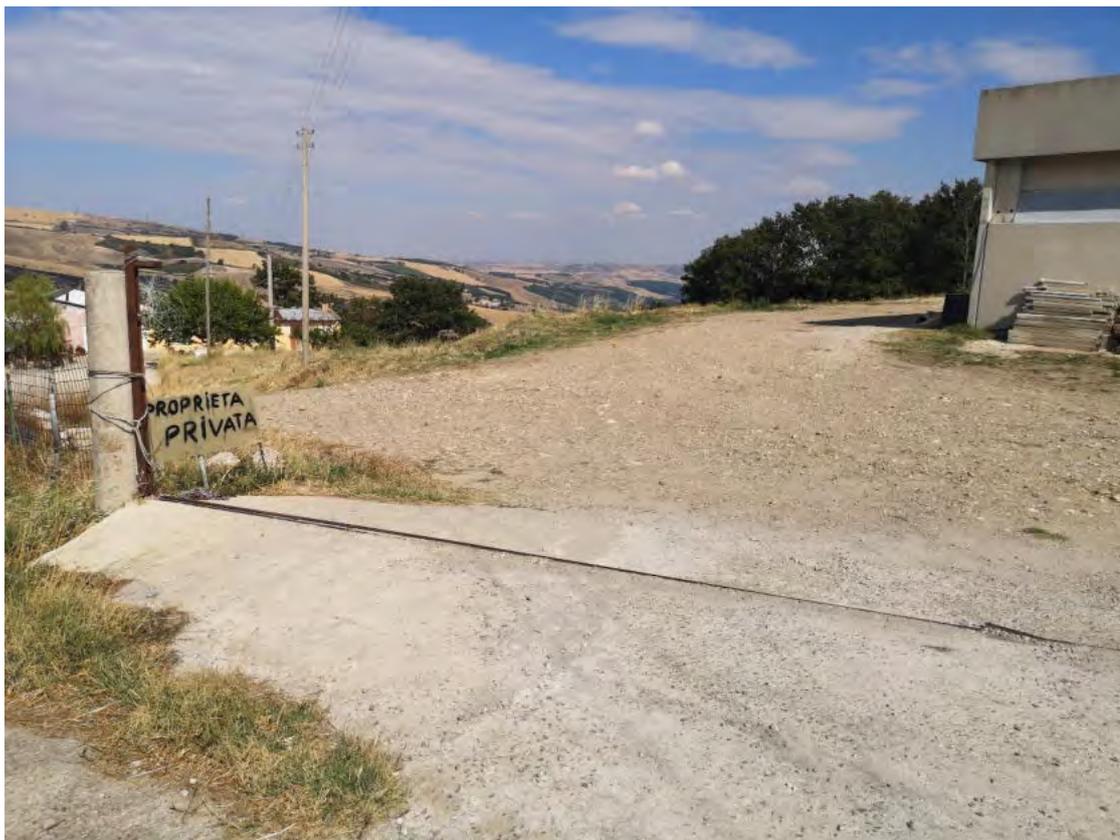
WTG 7, proprietà privata. AREA INACCESSIBILE.
